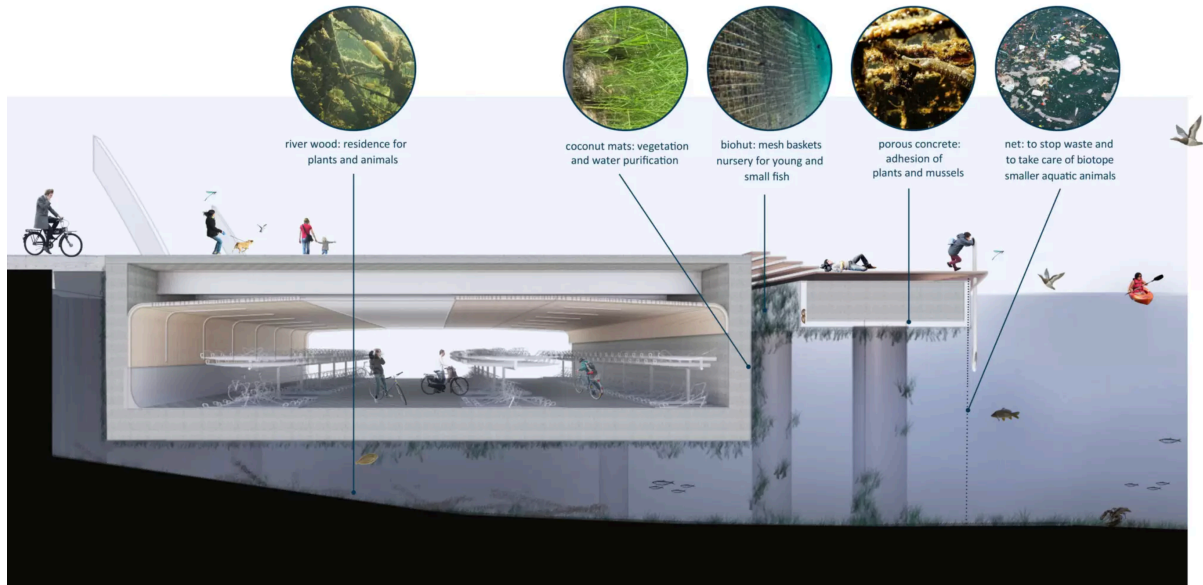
, Corte Esquemático IJboulevard, Ámsterdam
